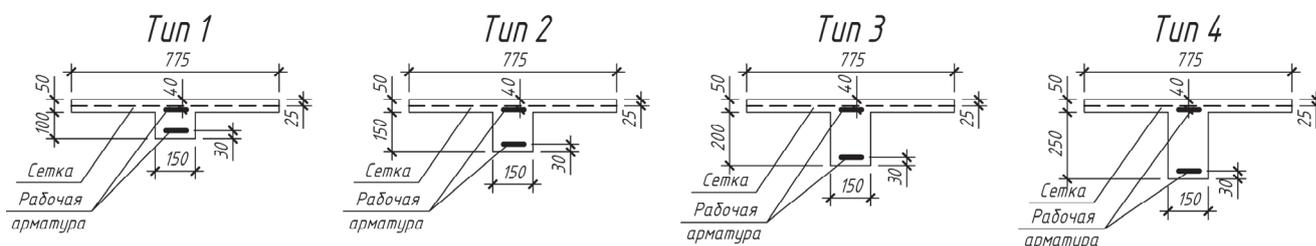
Расчетные сечения для определения опорного армирования
